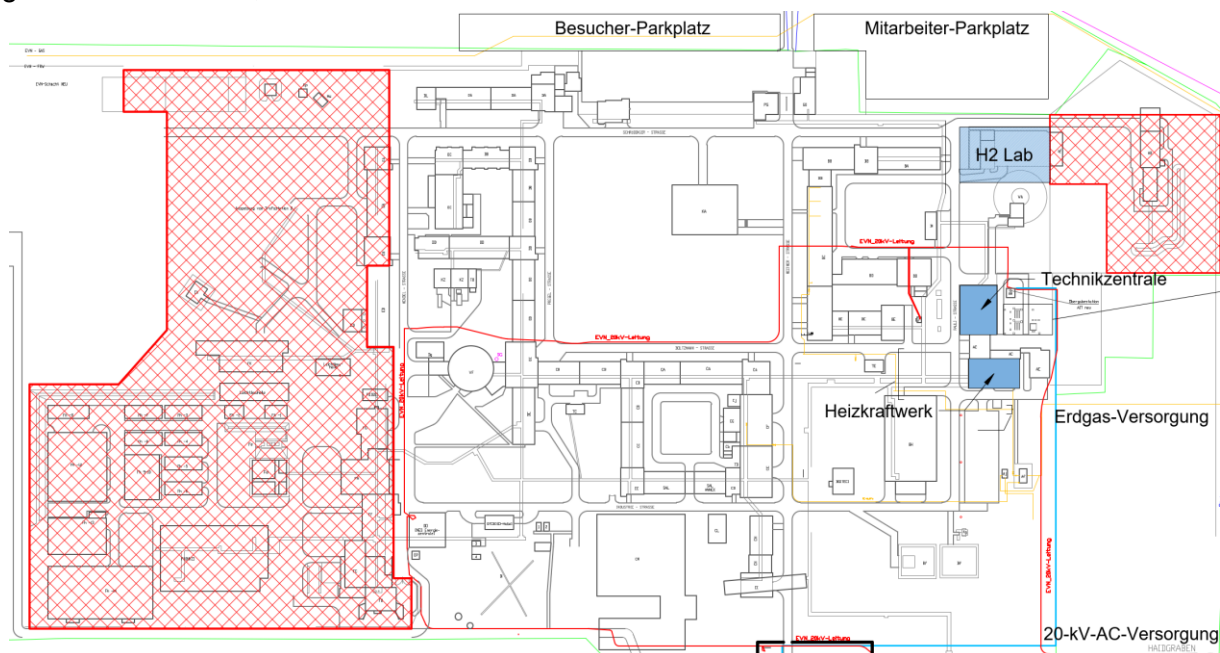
Standort Seibersdorf: Technikplan – Bestandsanlagen
